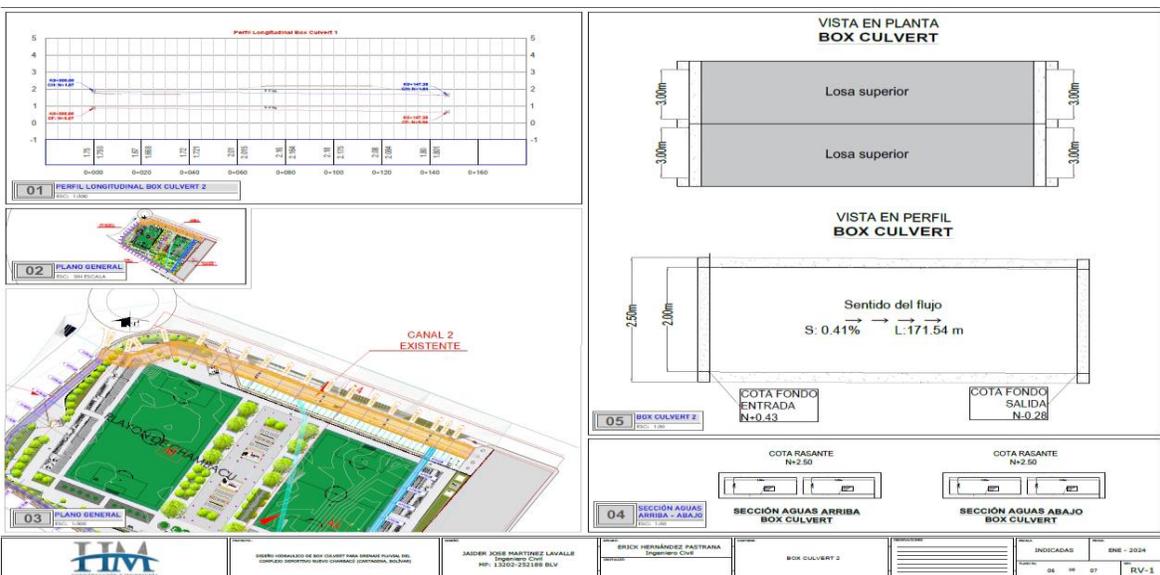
Planos y dimensiones de diseño de Box culvert 2
